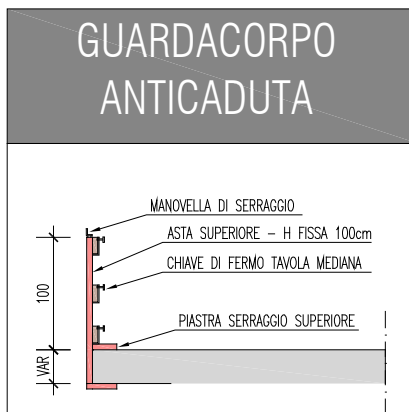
protezione contro la caduta dall'alto – opere in ca
